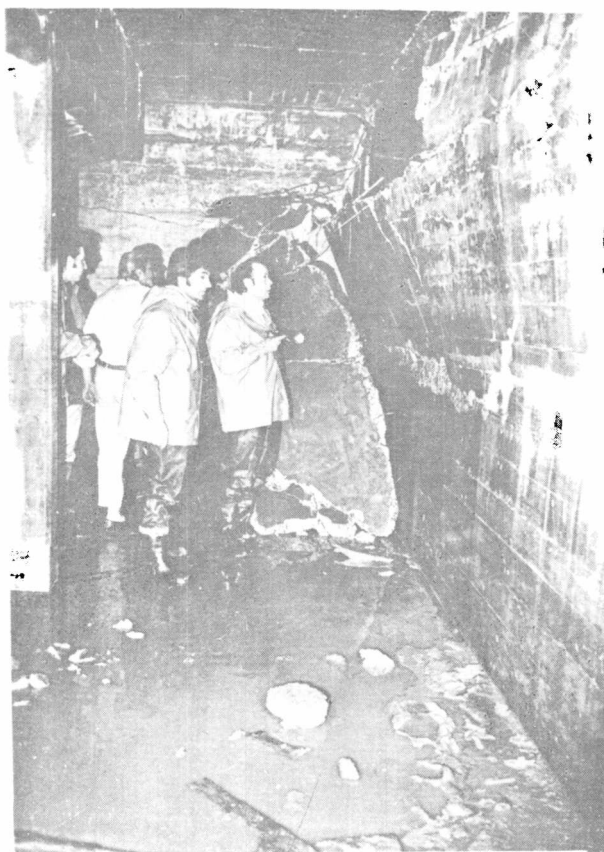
Colapso de estructura de hormigón armado. Corrosión de armaduras.
